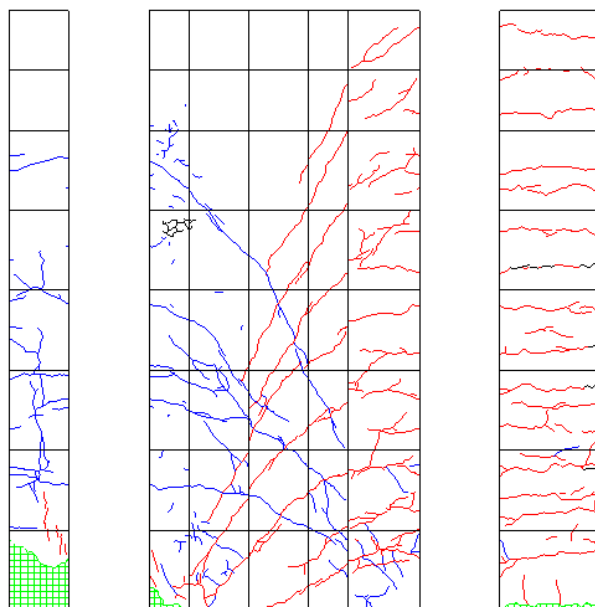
R=1/33②ひび割れ図
